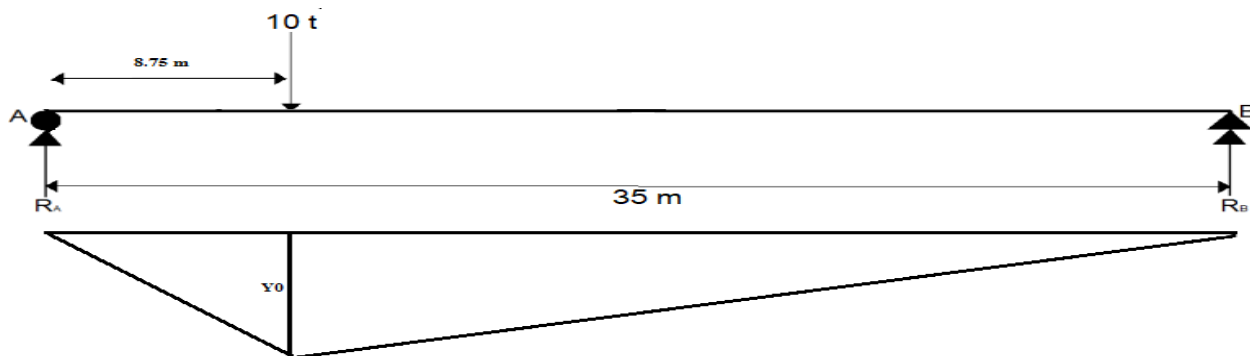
Disposition du convoi Br (pour la section $x=0.25L$)
